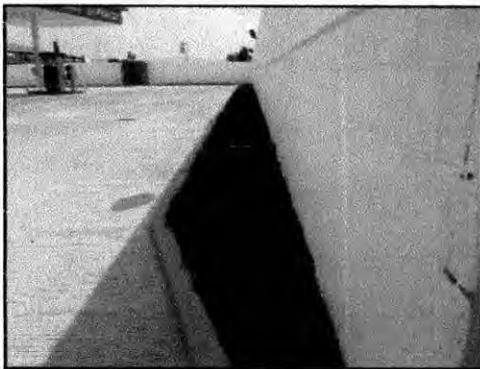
Bardas en las Colindancias sur y poniente
